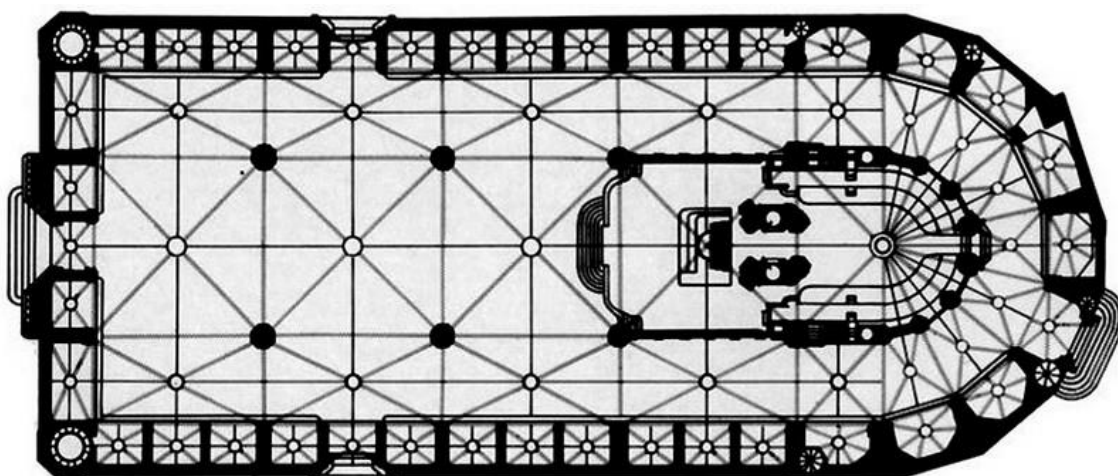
°. Planta de Santa María del Mar de Barcelona.
